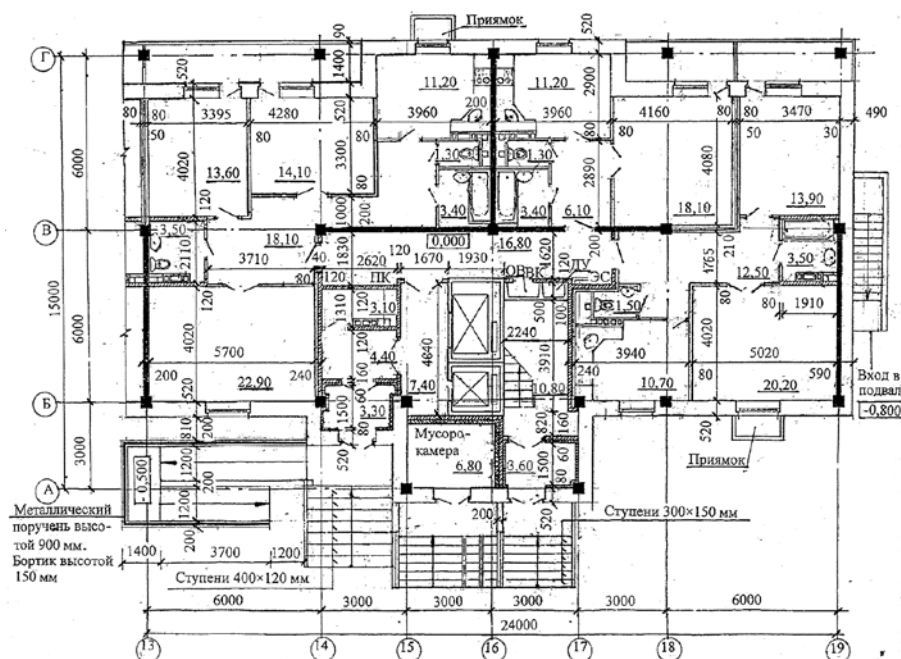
План первого этажа 14-ти этажного каркасного жилого дома:
